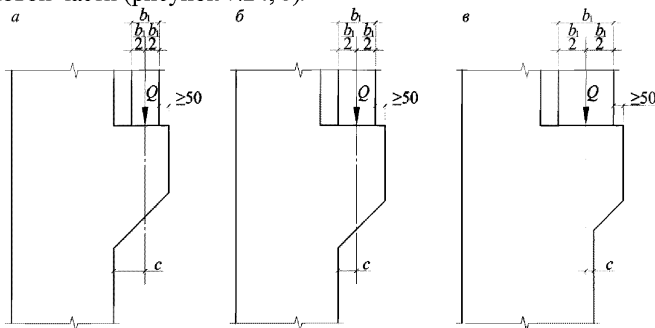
Схемы приложения крановой нагрузки на консоль
